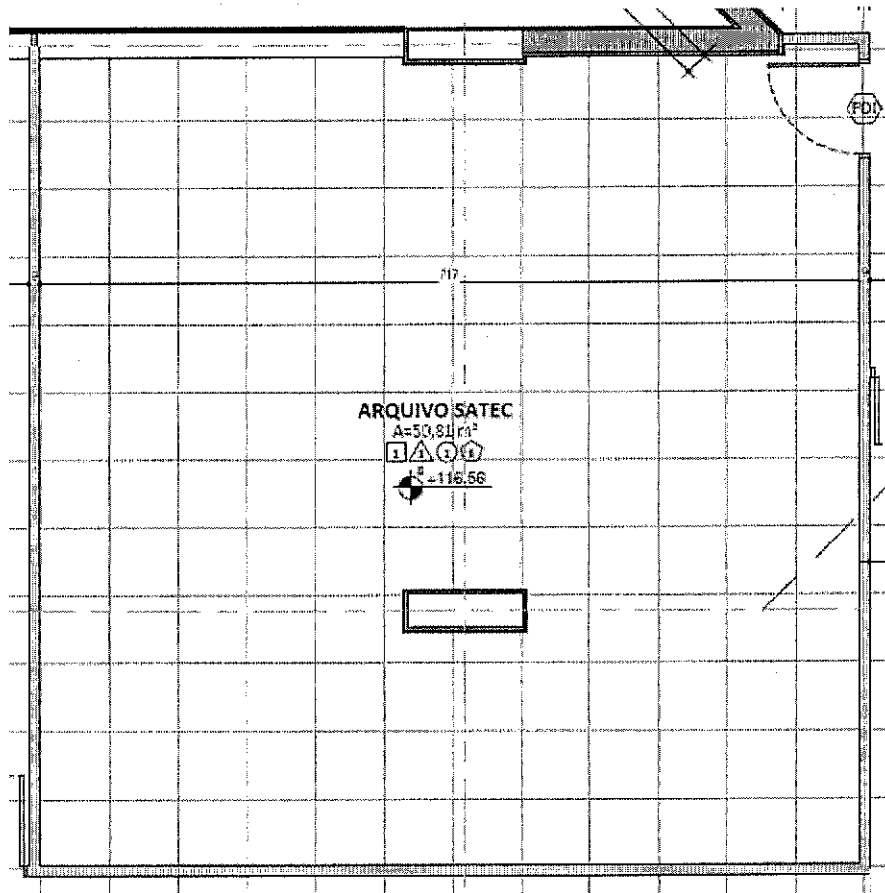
planta do 3º pavimento da obra DRF Bauru (CAT 2620180009585), área de arquivo com 50,81m². Obra de Construção.
